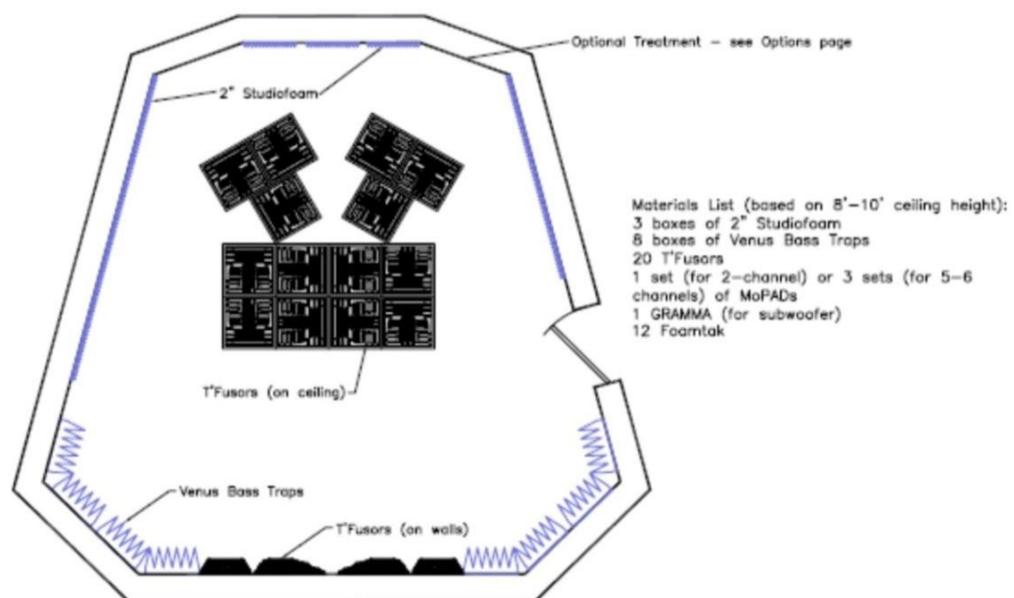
Layout Studio Rekaman dan Detail Akustik Ruang
